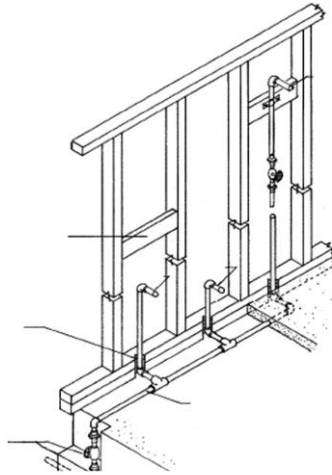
Detalle fijación tubería de agua y desagüe con abrazaderas metálicas galvanizadas.
